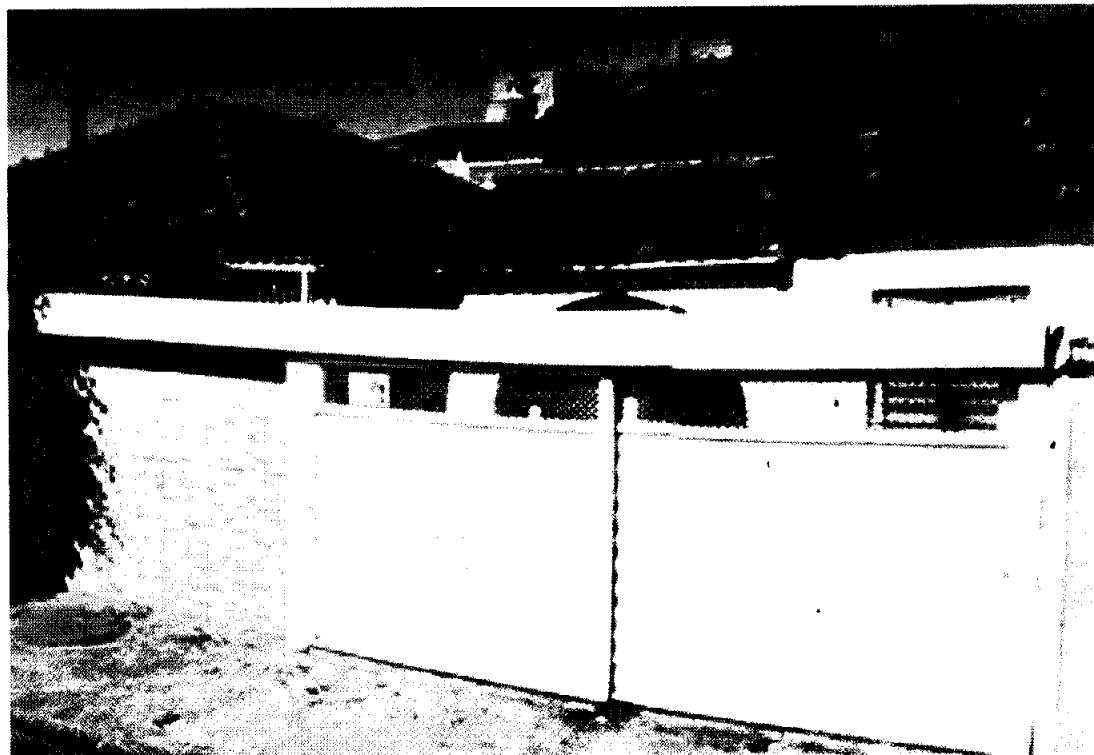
Foto B: Fachada da casa residencial avalianda na Rua Pereira Simões, 352 – Olinda - PE
